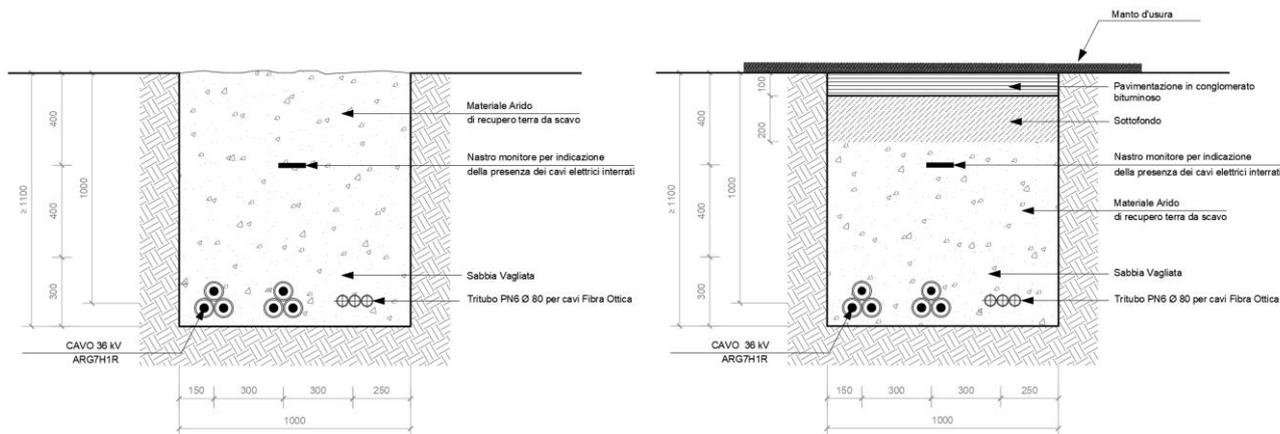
Tipico modalità di posa cavidotto a 36 kV di collegamento impianto - RTN
